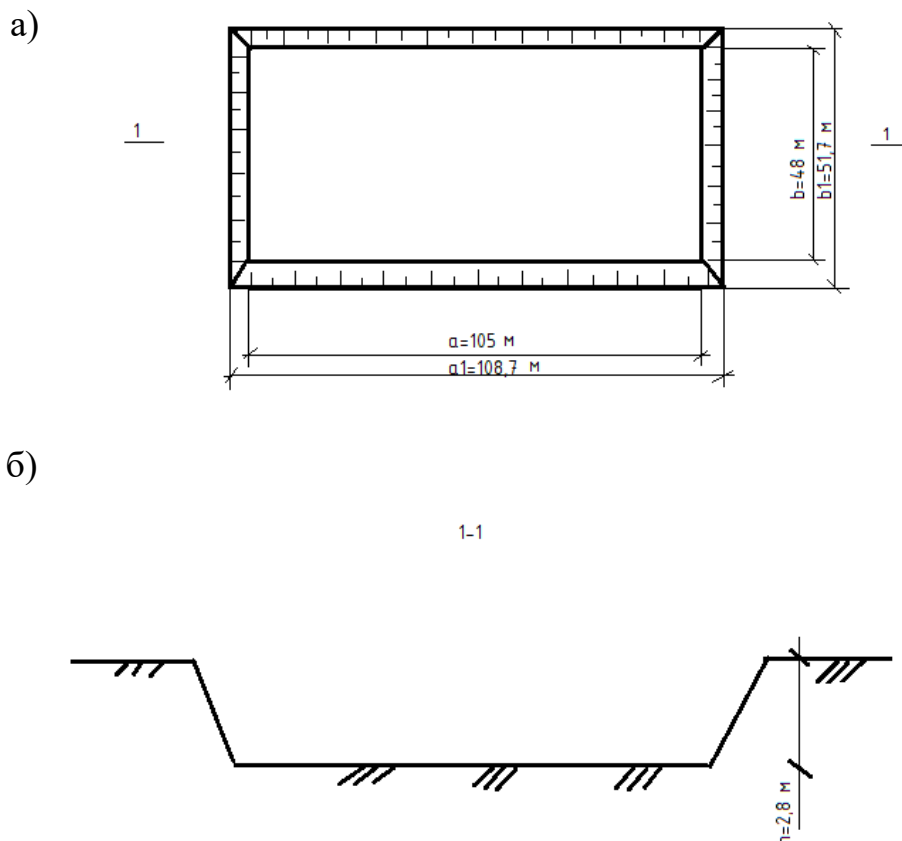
Схема котлована: а – план; б – разрез 1-1
